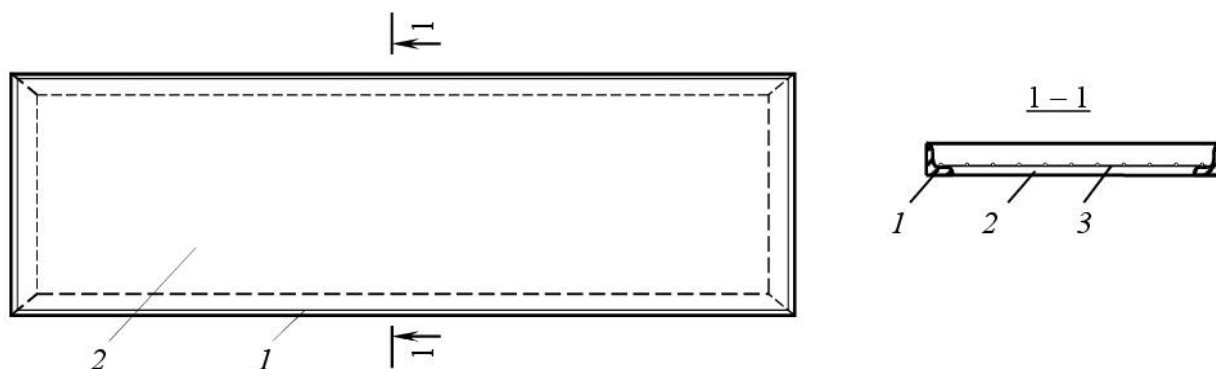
Збірна залізобетонна плита перекриття зі сталевим обрамленням:
